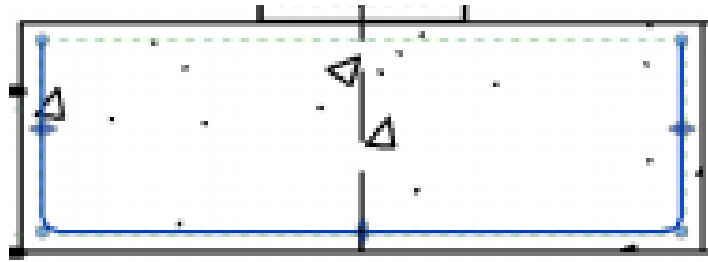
Armadura tipo 21. Familia de la biblioteca de Revit
